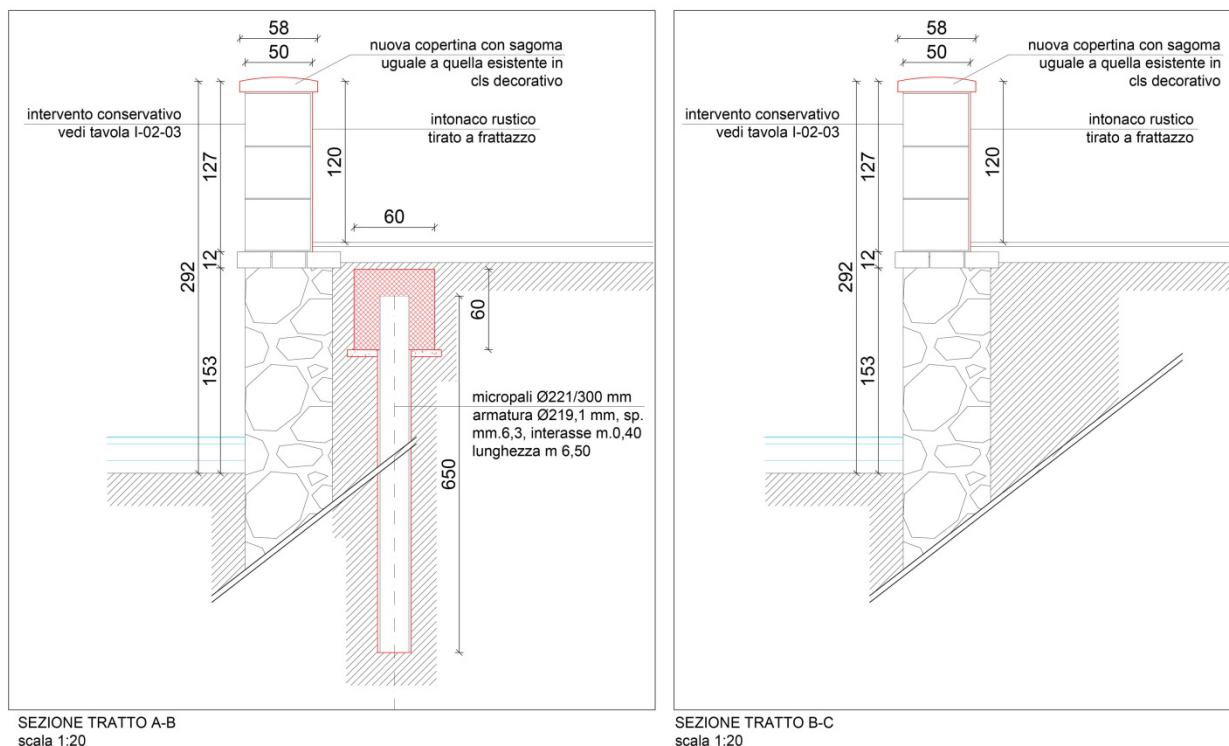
Interventi sui tratti di muro di via spalto piodo : tratto a-b (12 m) e tratto b-c (113m)
